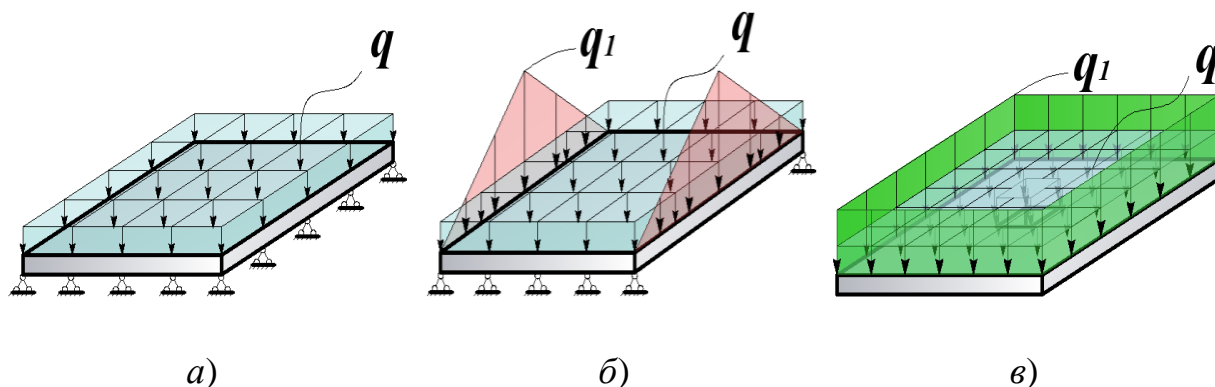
Схеми завантаження елементів перекриття:
